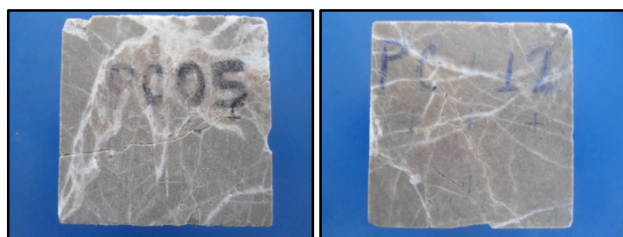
a) Grieta en la probeta PC05; b) Ruptura en la probeta PC12.
